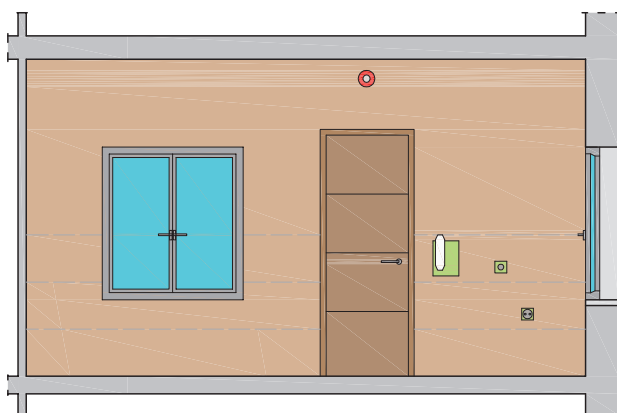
Detalle de alturas para la colocación de instalaciones.
